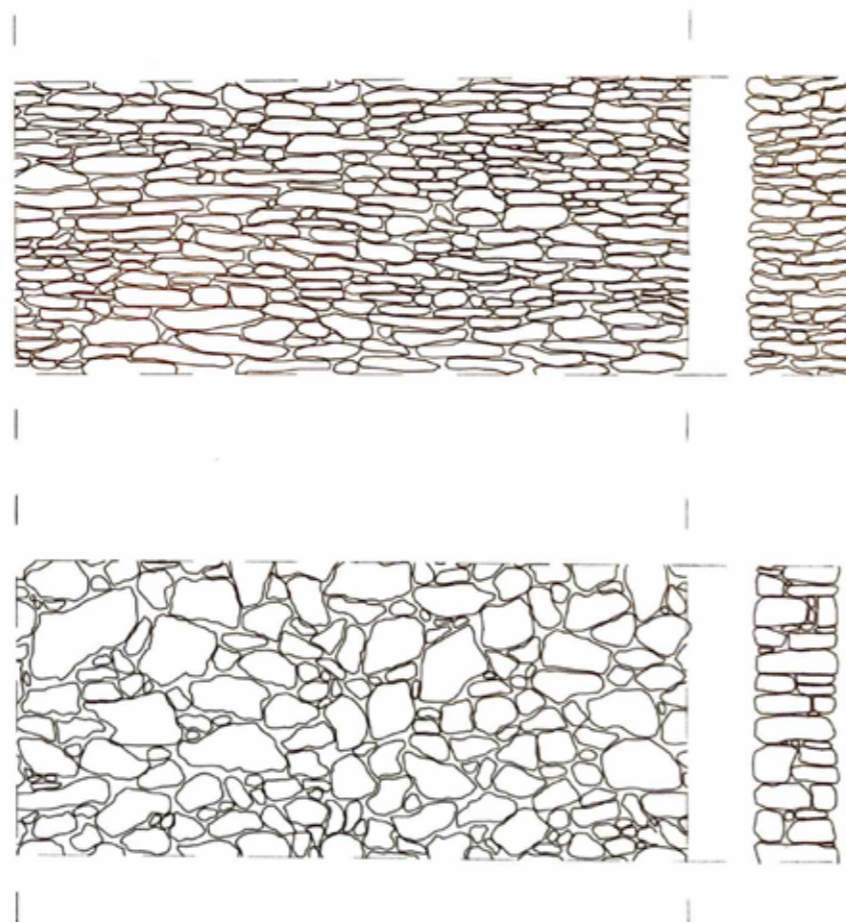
Ejemplos muros de Piedra Seca (Fuente: Aprendiendo a restaurar)
